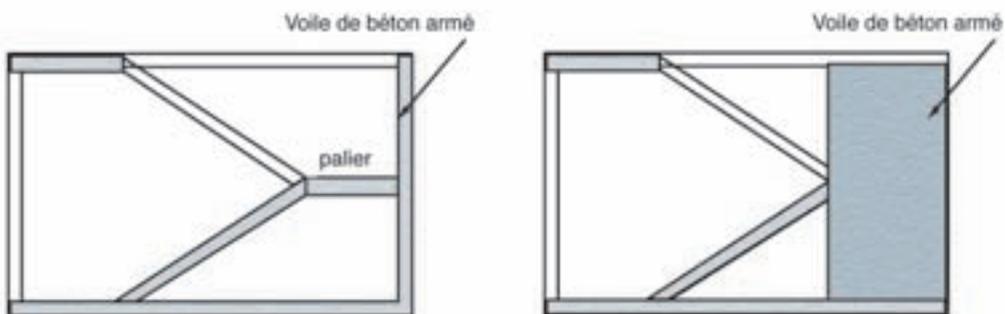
Solutions supprimant l'effet de poteau court dû aux paliers d'escalier : voiles en fond de la cage d'escalier ou voiles latéraux (meilleure solution)
